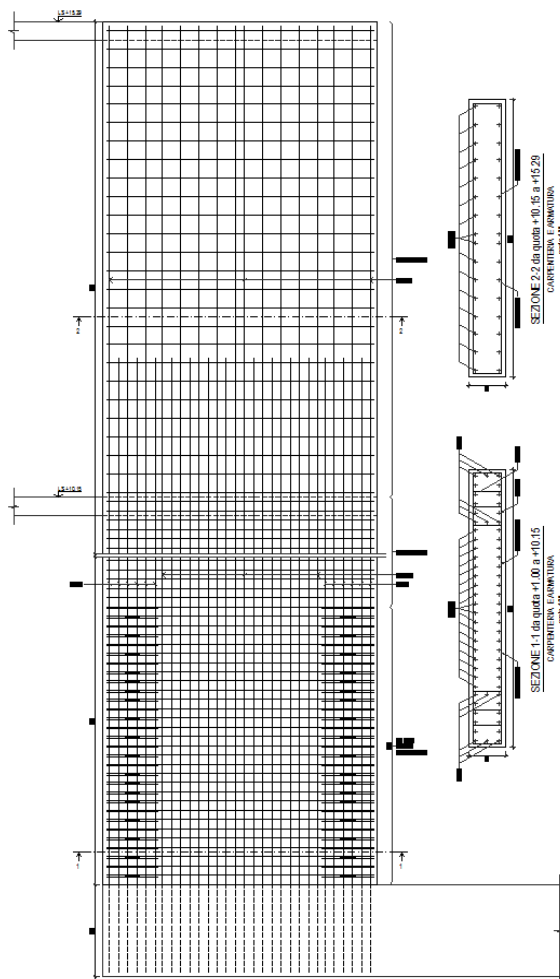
Disposizione delle armature nel setto tipo 300 x 40 cm.
